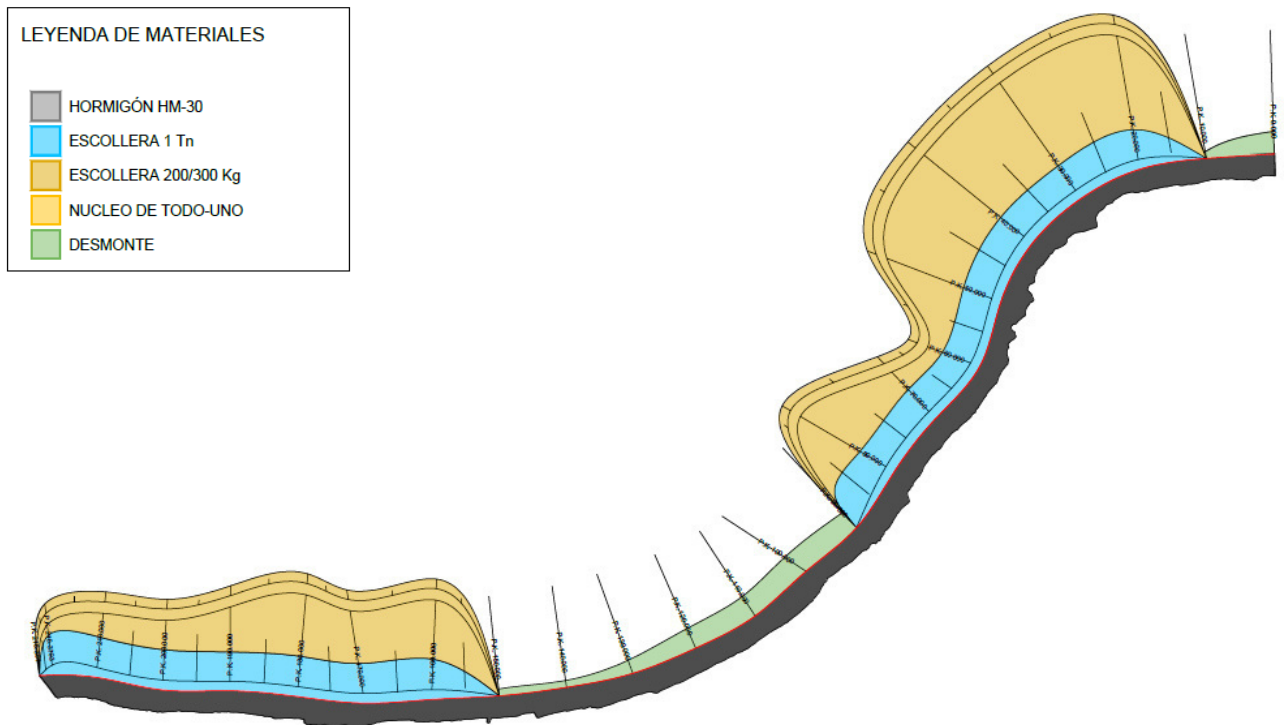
Planta propuesta con las dos tipologías de secciones.
